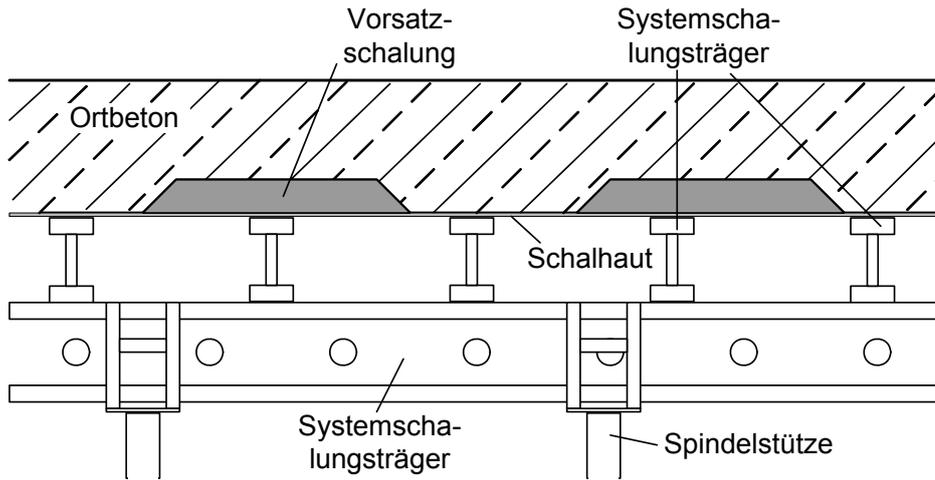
Aufbau einer konventionellen Decke mit Vorsatzschalung
